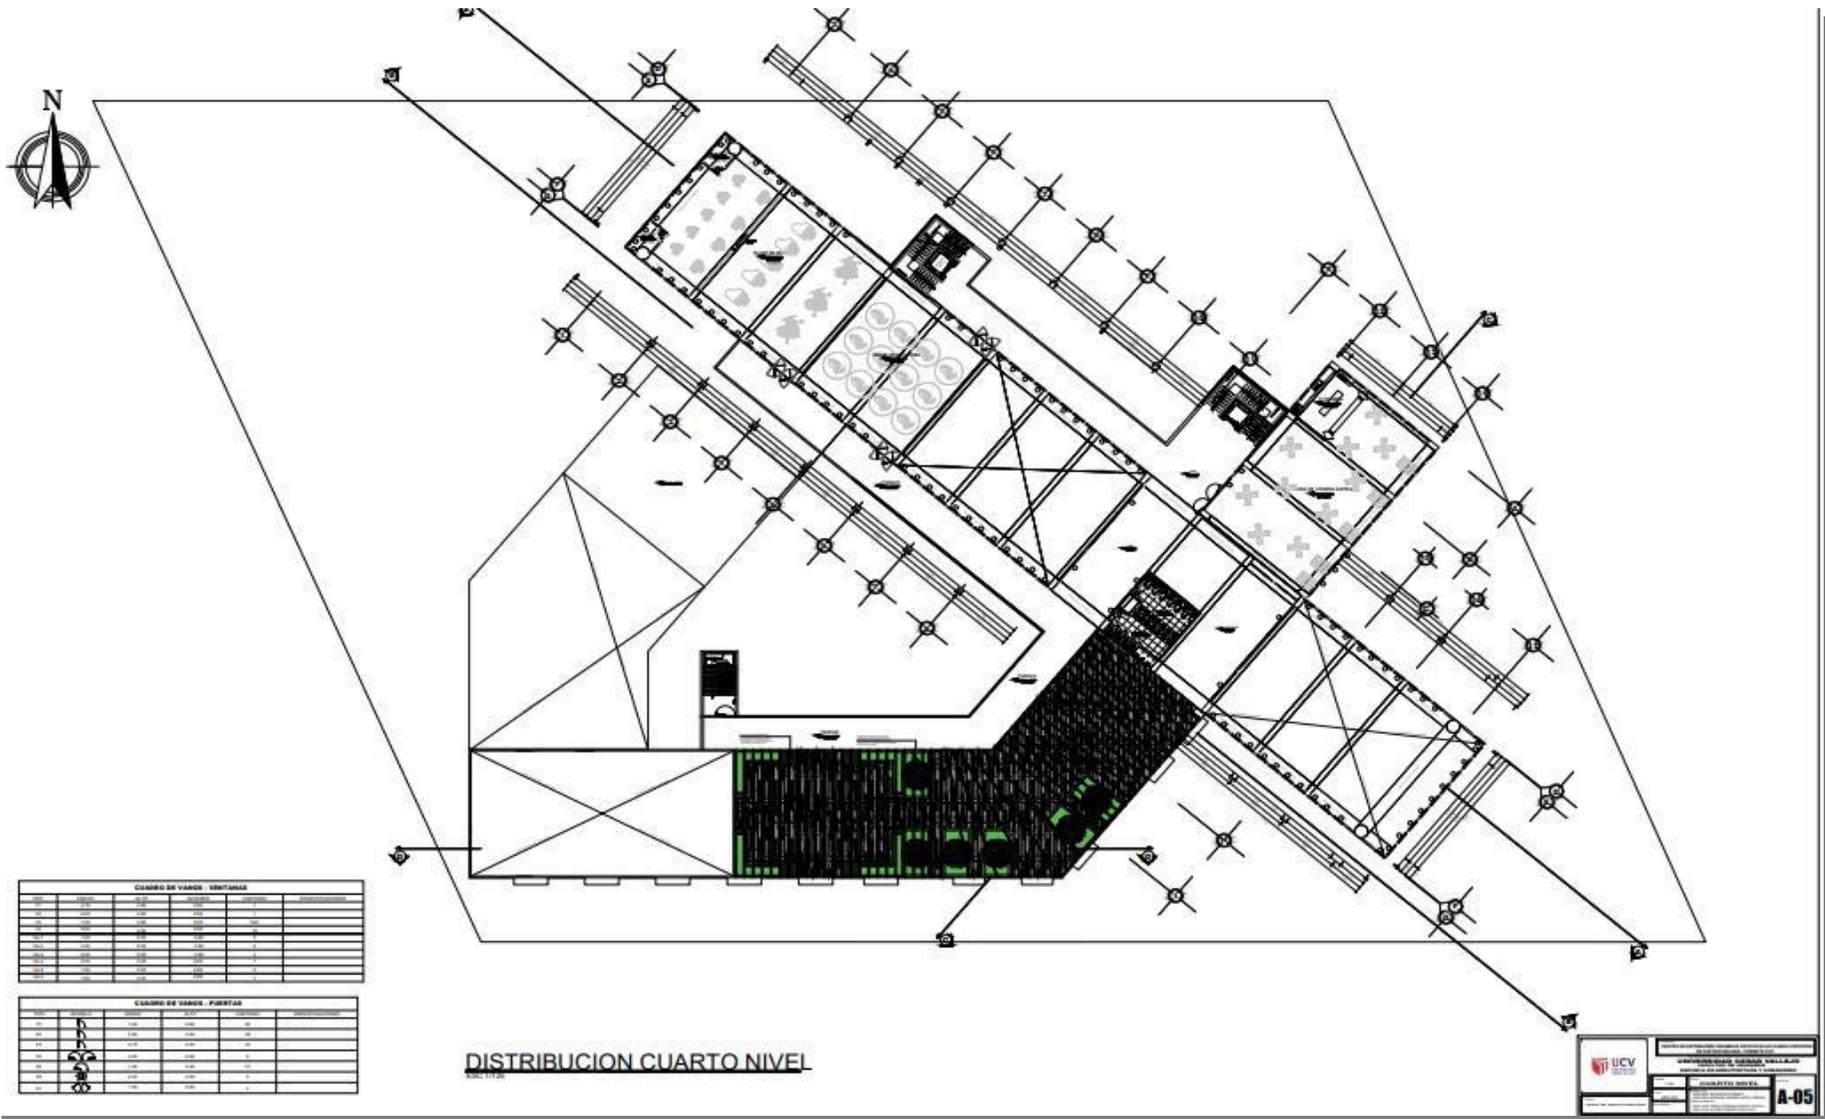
Plano de distribución 4 nivel Fuente: Elaboración Propia
